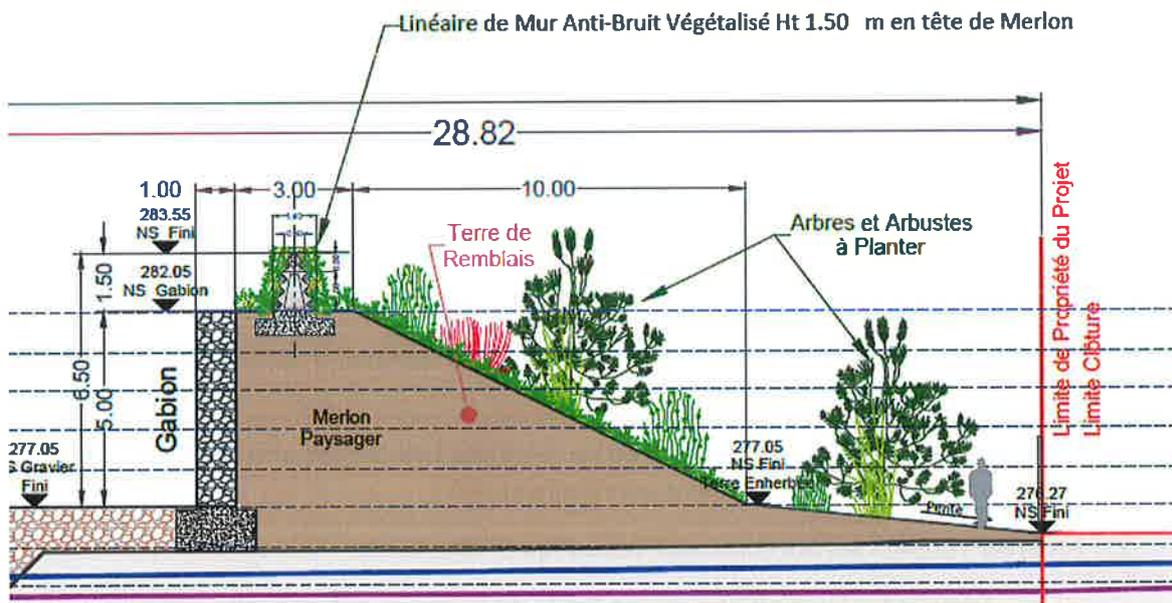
Plan de coupe longitudinale AA avec merlon à 8/4, superposé d'un mur anti-bruit de 1.5 mètre, et planté d'arbres – dossier de plans modificatifs (juillet 2024). La couleur utilisée pour symboliser le merlon (remblai de terres) a été modifiée pour plus de lisibilité.
